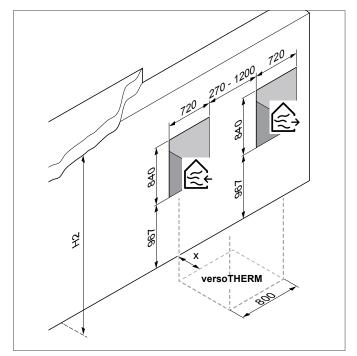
Installazione parallelamente alla parete, ingresso aria a destra
